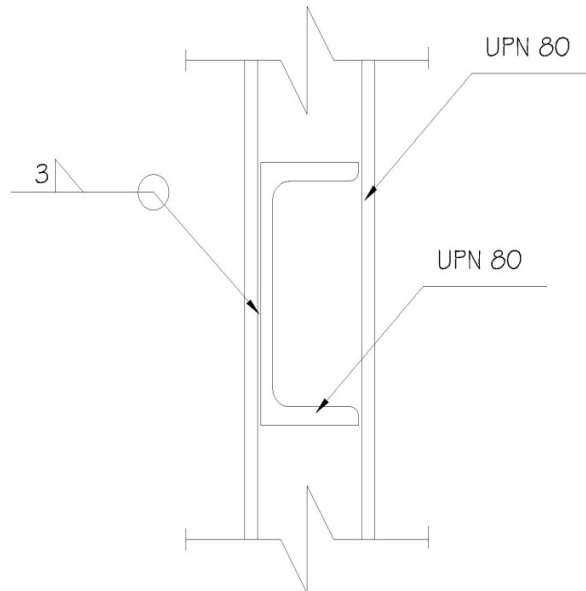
Detalle de soldadura para perfil UPN80.
